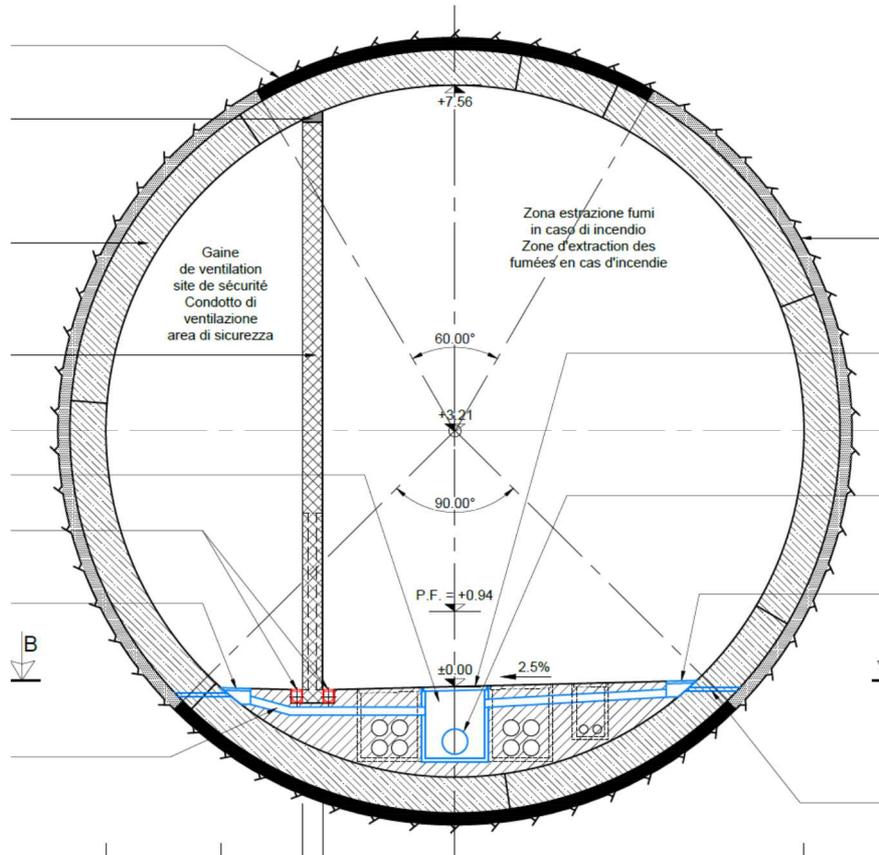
sistema di drenaggio della sezione corrente - galleria Maddalena 2
